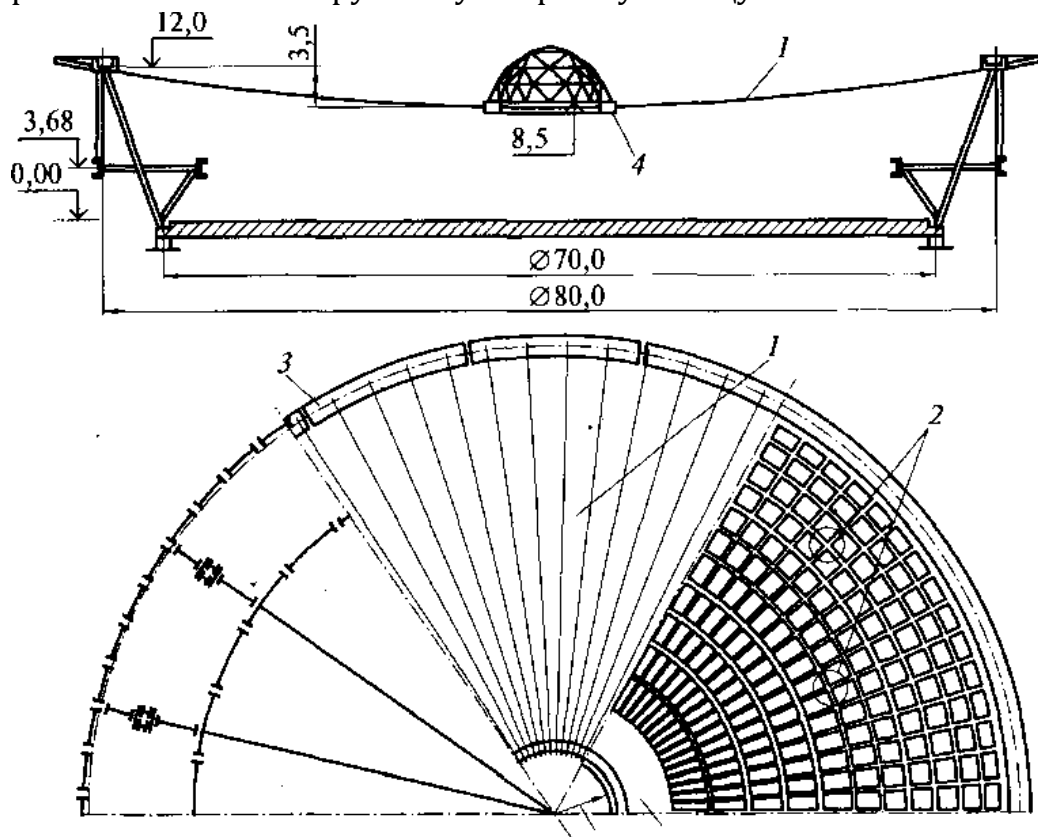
Висячее покрытие на круглом плане: 1 – стальные несущие ванты, 2 – железобетонные плиты; 3 – опорная конструкция.
